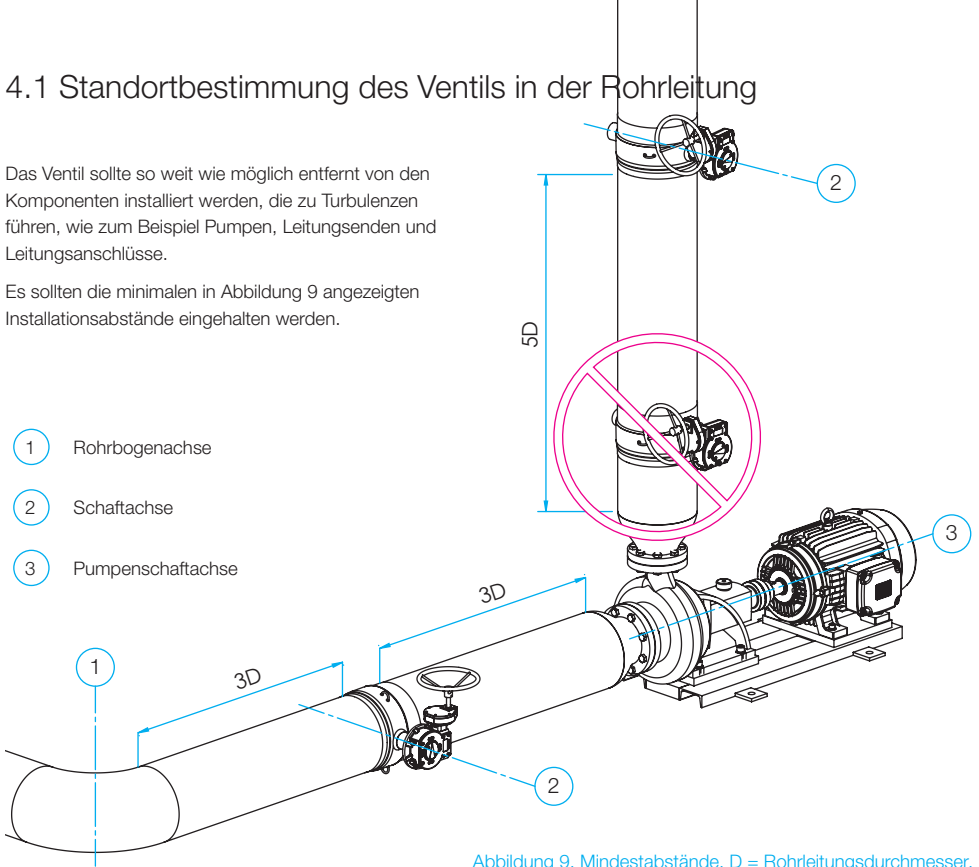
Mindestabstände, D = Rohrlängendurchmesser.
